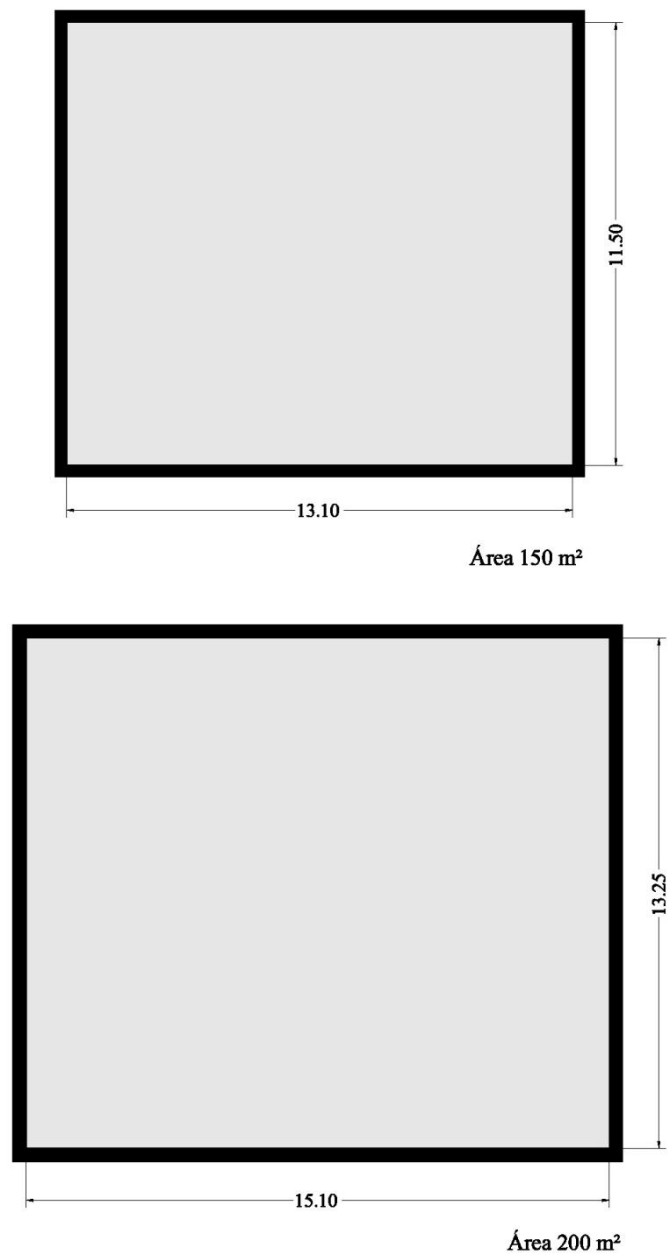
Planta de dos aulas correspondientes a las dimensiones obtenidas anteriormente.
